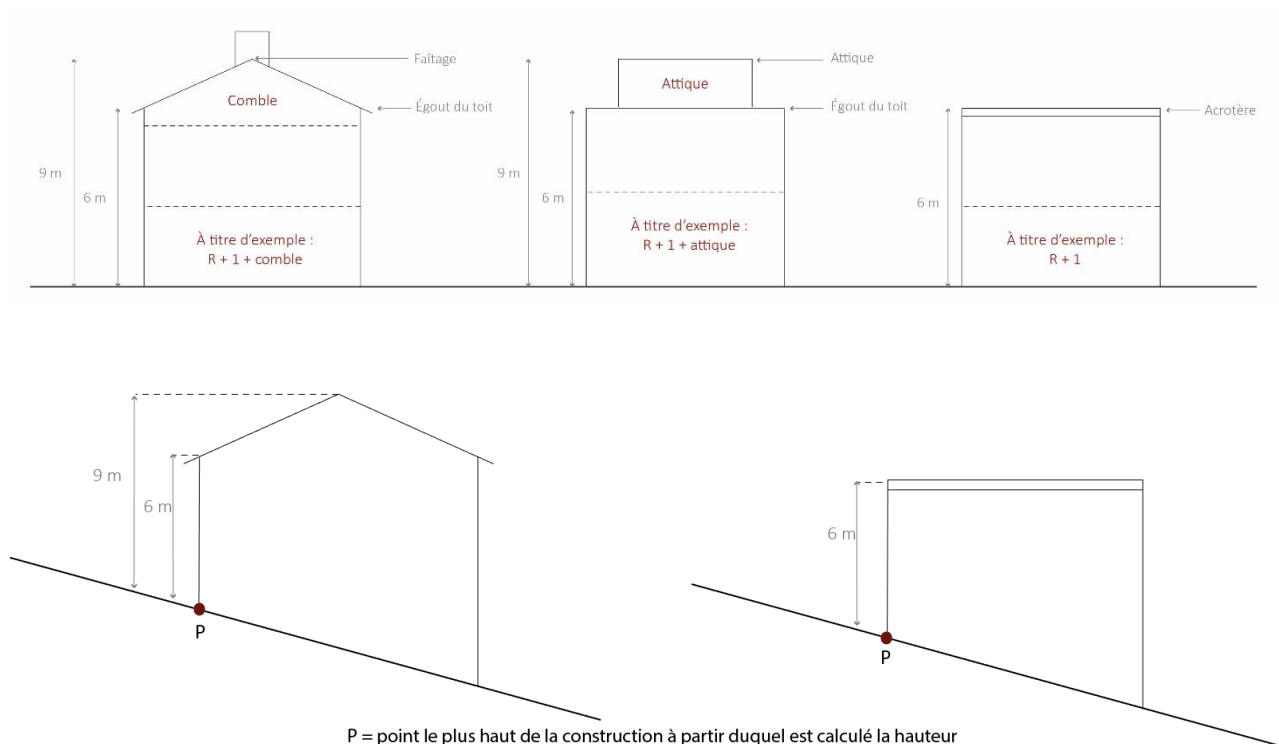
\_ Hauteur maximale autorisée dans la zone UB
